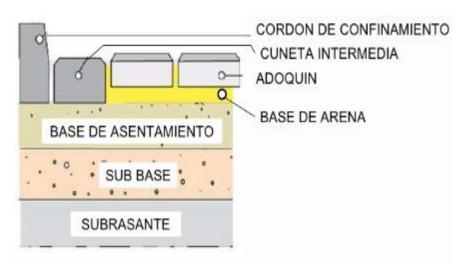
Esquema de Pavimento Articulado Fuente: Instituto mexicano del cemento y del concreto
